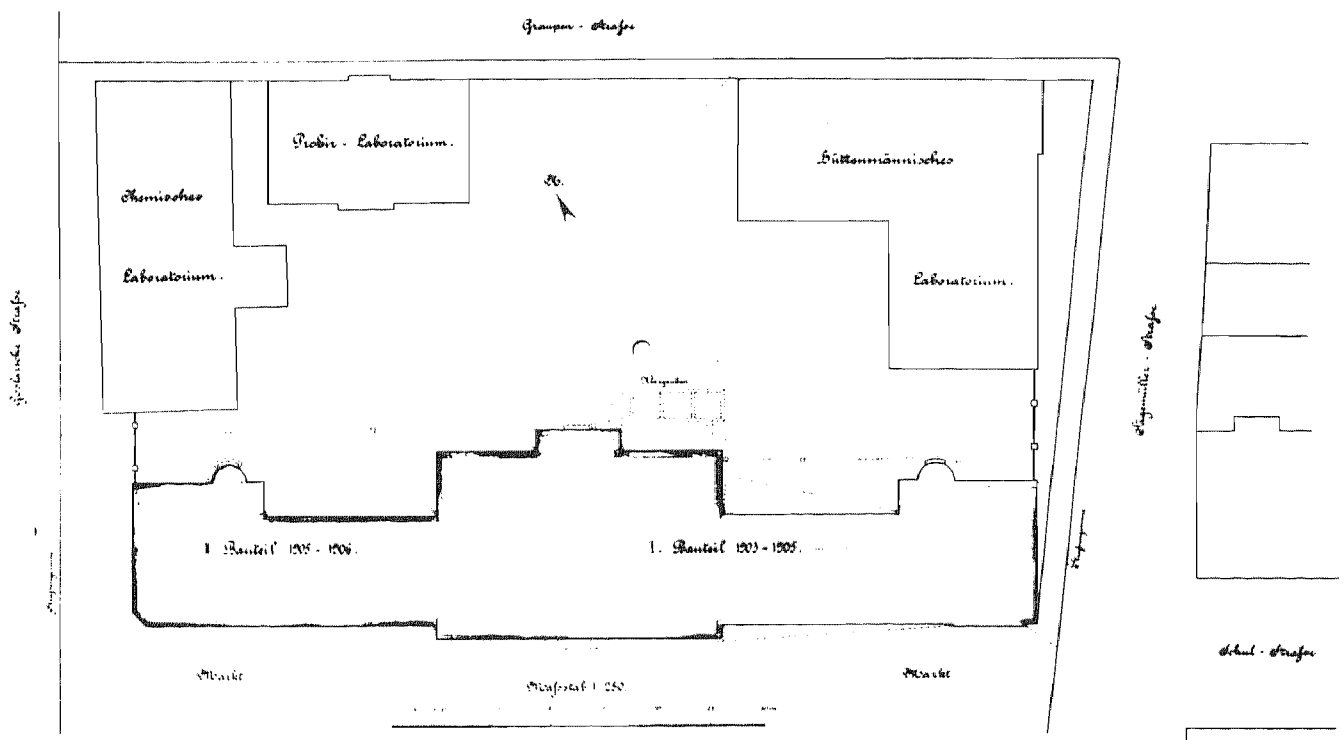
Lageplan des neuen Hauptgebäudes der Bergakademie Clausthal. Erster Bauabschnitt 1903–05; zweiter Bauabschnitt 1905–06.
